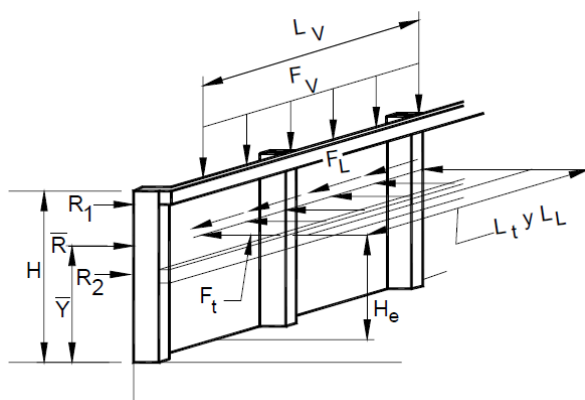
Cargas en una baranda metálica, donde se aplican tanto en altura y longitud de distribución horizontal.
